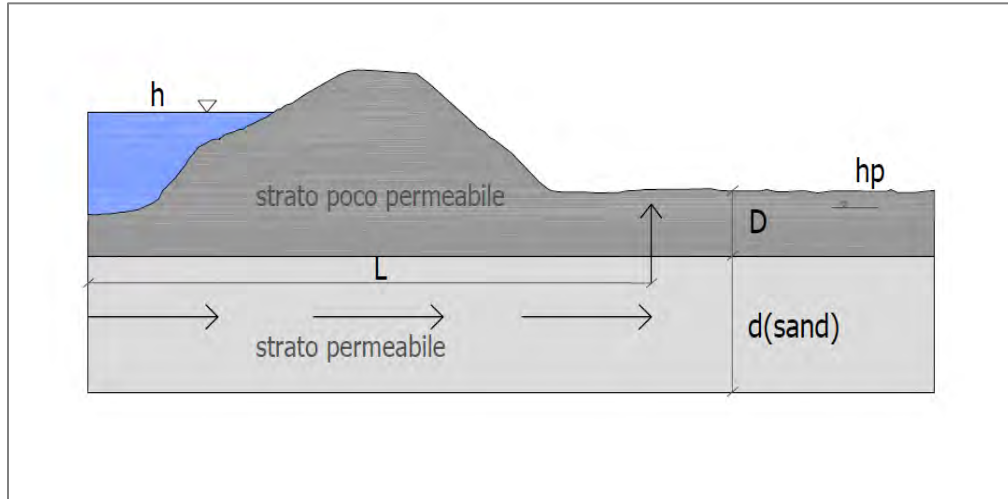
Schematizzazione della sezione secondo il modello di Bligh
